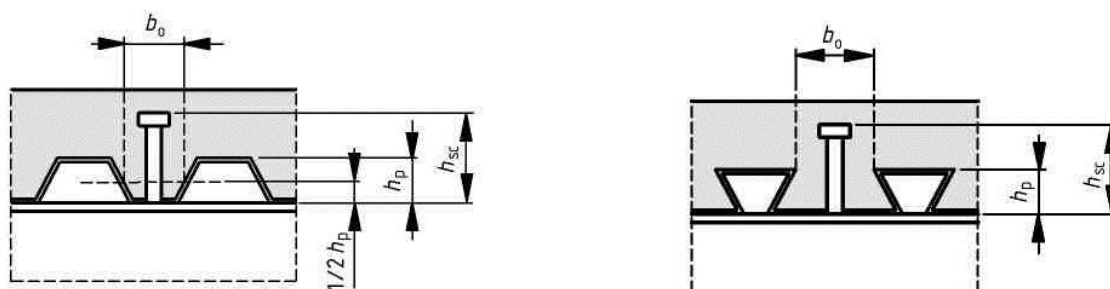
Бетонная плита со стальным профилированным листом, расположенным поперек балки
